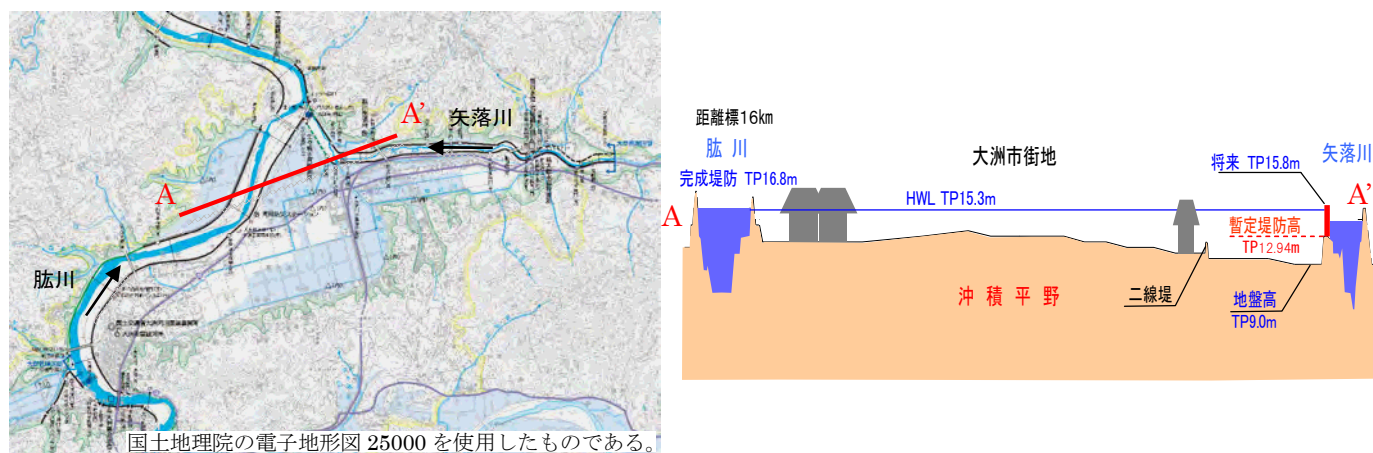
肱川沿川の地盤高（平面図、断面図）
